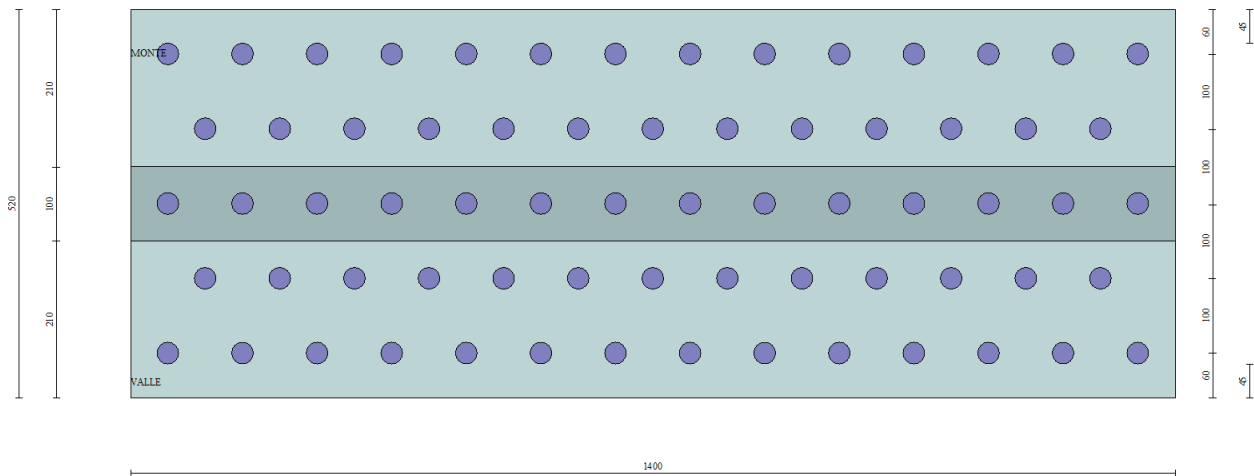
Muro Tipo B: disposizione dei micropali di fondazione.
